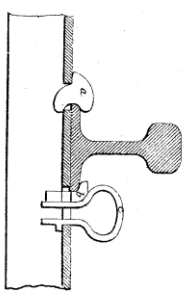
Coupe d'un rail longue (1/4 de déca°).
